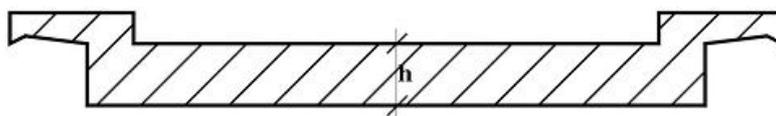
Seção transversal de tabuleiro de ponte em laje maciça (Fonte: VITÓRIO, 2002).
